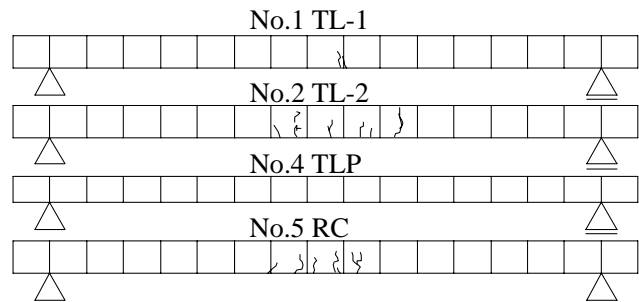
長期載荷実験最終ひび割れ状況
